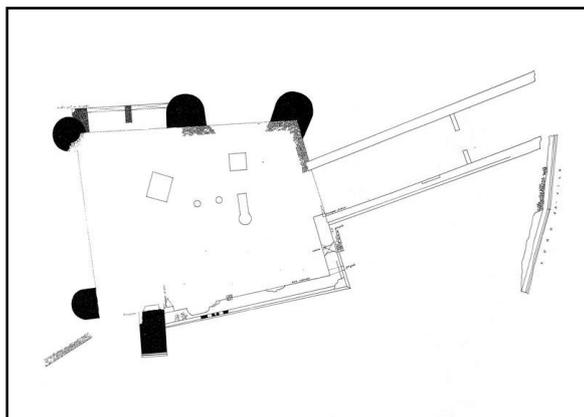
Planta do Paço dos Alcaides – <http://www.monumentos.pt> – Acesso em: 09/03/2011.
